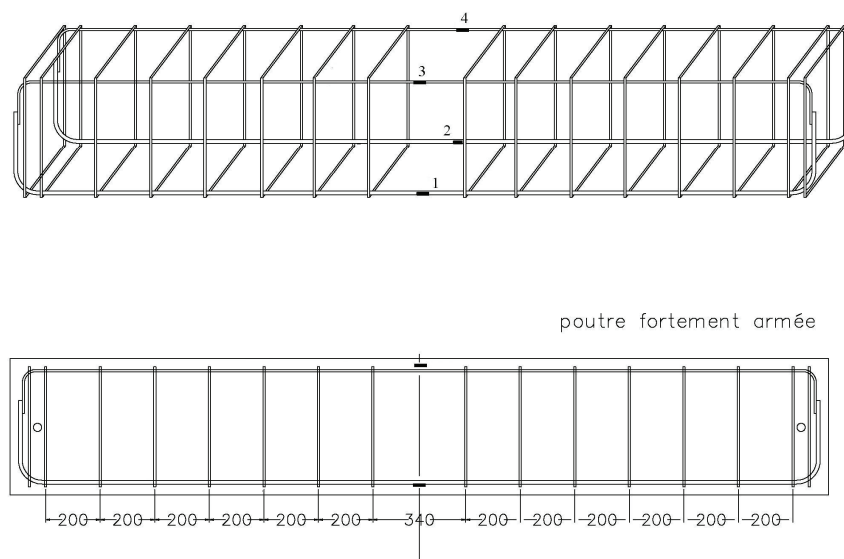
7 : plan d'instrumentation du ferrillage FA
